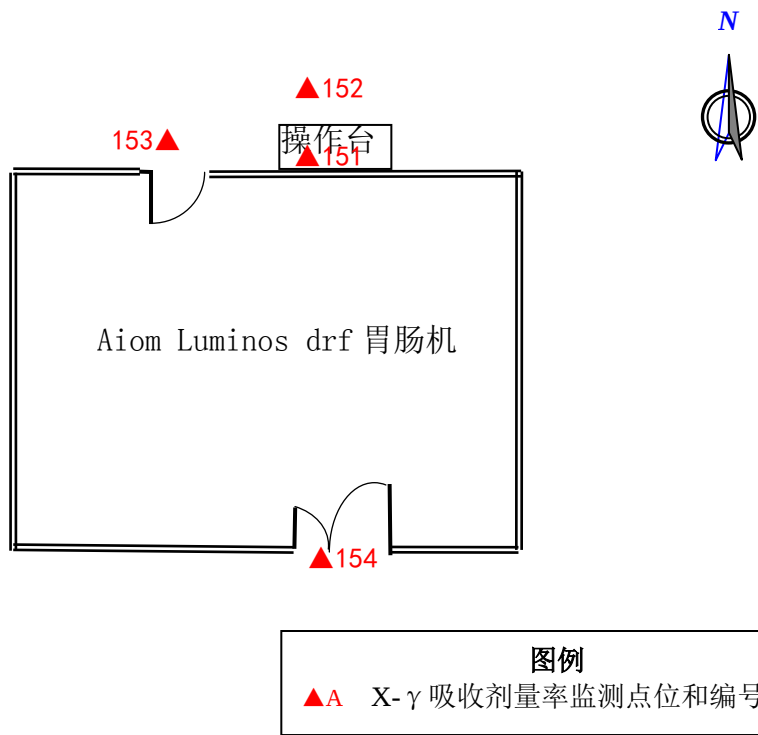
Aiom Luminos drf 胃肠机房平面布置简图及监测点位图
